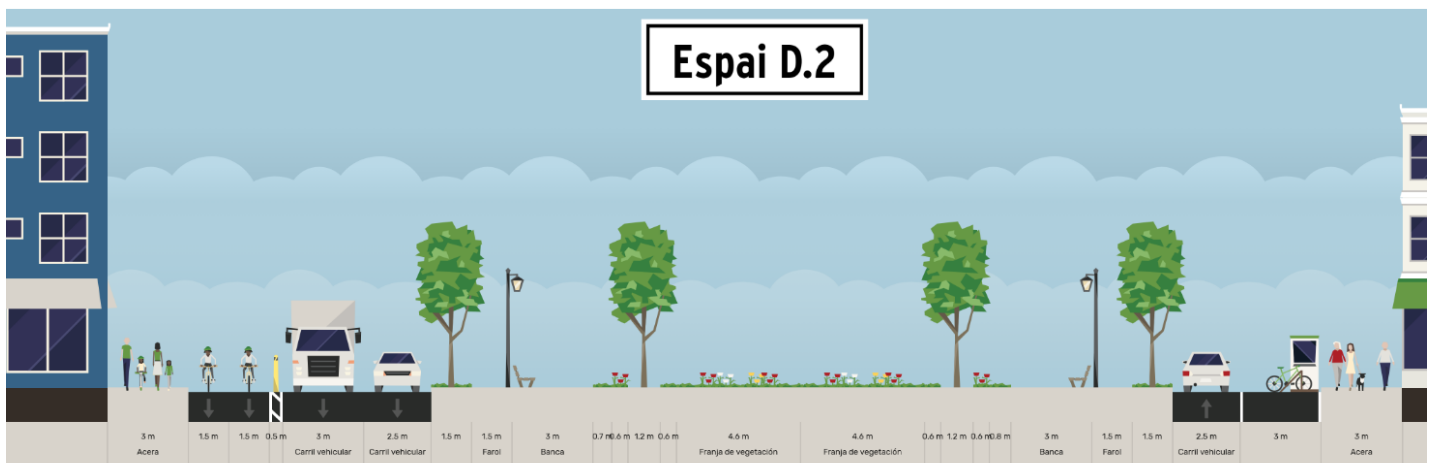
proposta de secció per a l'espai D.2 [Font: aplicació streetmix.net i elaboració pròpia]
